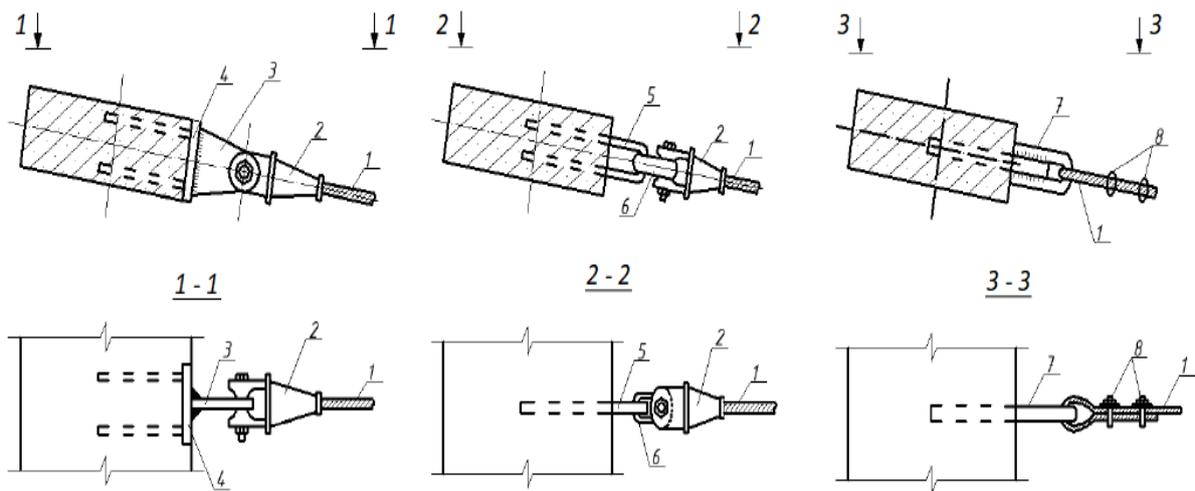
Анкерное крепление вантовых канатов к железобетонным конструкциям: 1 – ванты; 2 – анкерное устройство; 3 – пластина; 4 – закладная пластина; 5 – петлевидная закладная деталь; 6 – соединительная «серьга»; 7 – вилкообразный захват
